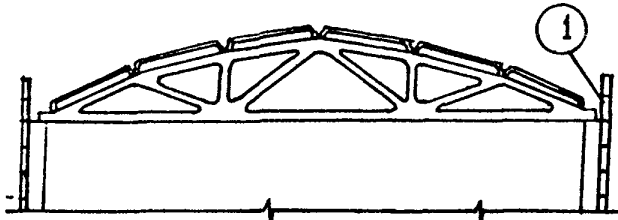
Выполнение кровельных работ на покрытиях с уклоном более 20° с использованием средств безопасности
